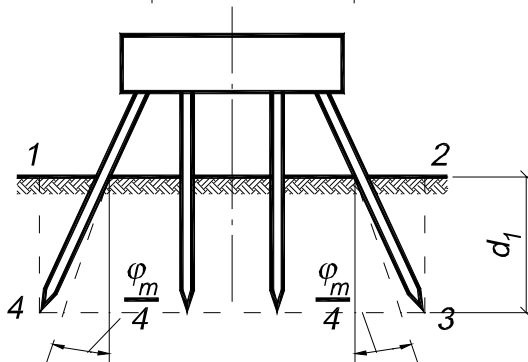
Умовний пальовий фундамент з ростверком, розташованим над ґрунтом при куті нахилу паль більше, ніж $\varphi_m / 4$
